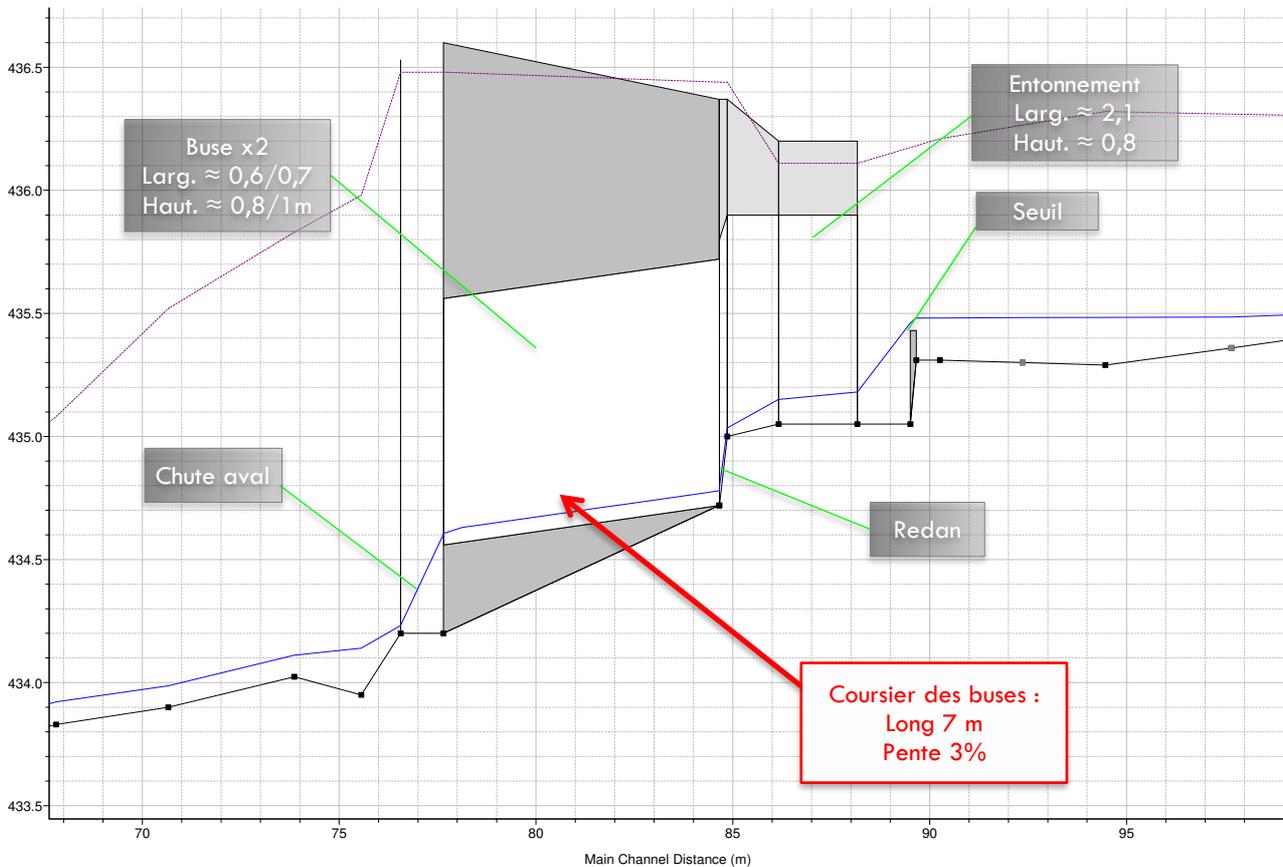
Profil en long du fond et principales dimensions de l'ouvrage
